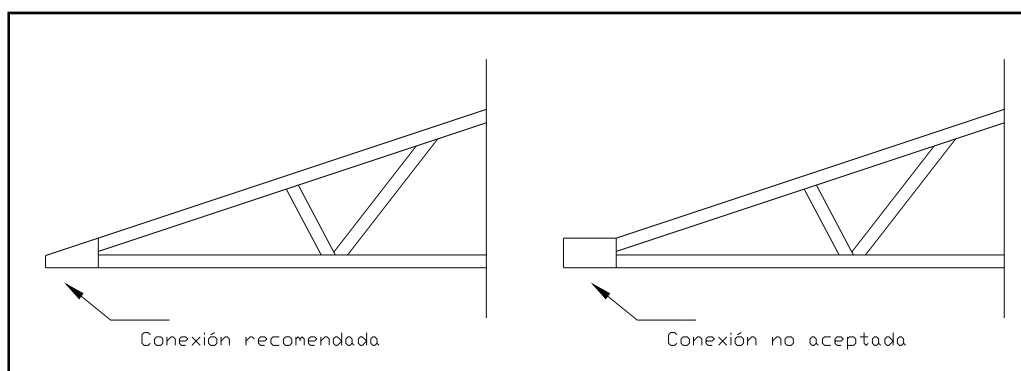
Detalle de conexión en las Puntas de los brazos de Suspensión
